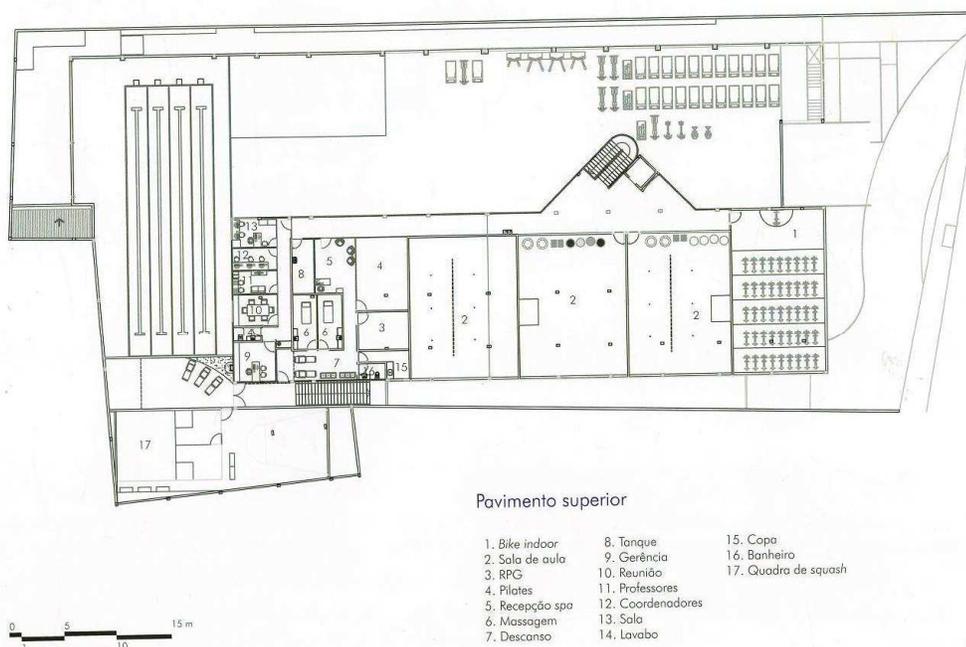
Planta Baixa do Pavimento Superior da Péle Club. Fonte: Cris Correa, 2011. p. 63
